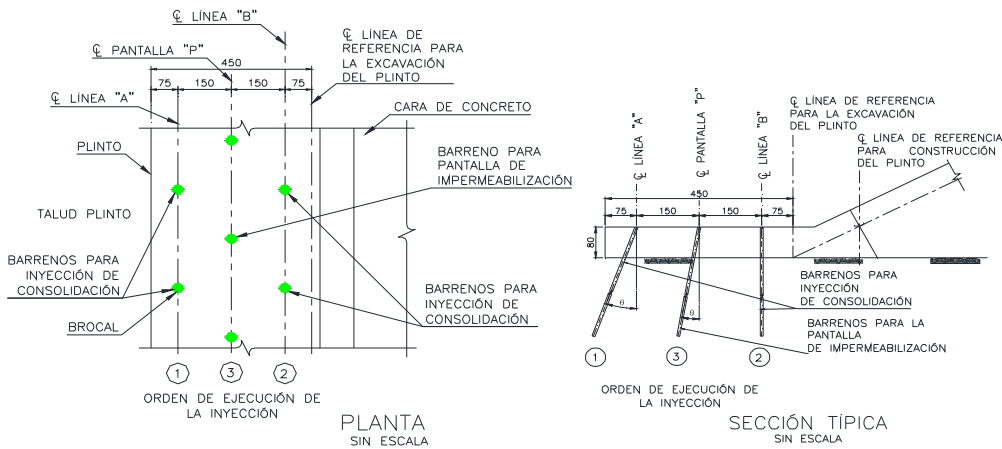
Planta y sección del Plinto y distribución de los barrenos de inyección en el tramo P12-P13.
